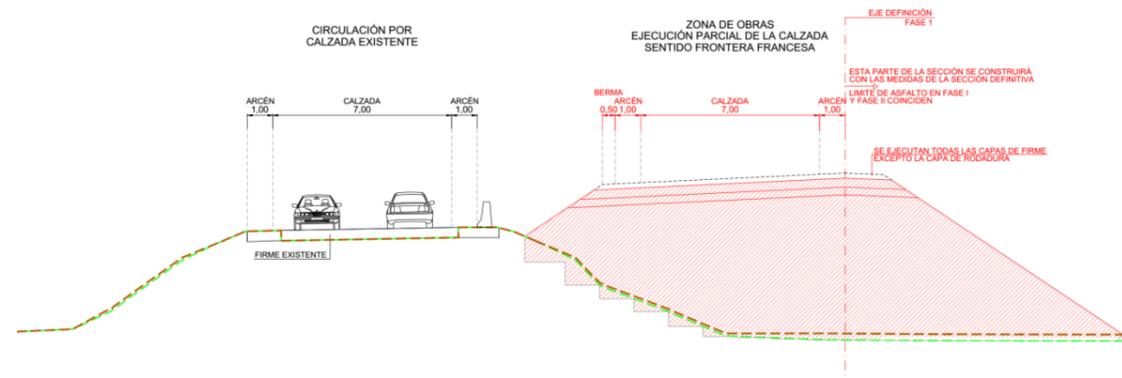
En rojo la zona de obras de Fase 1, sin precarga.
